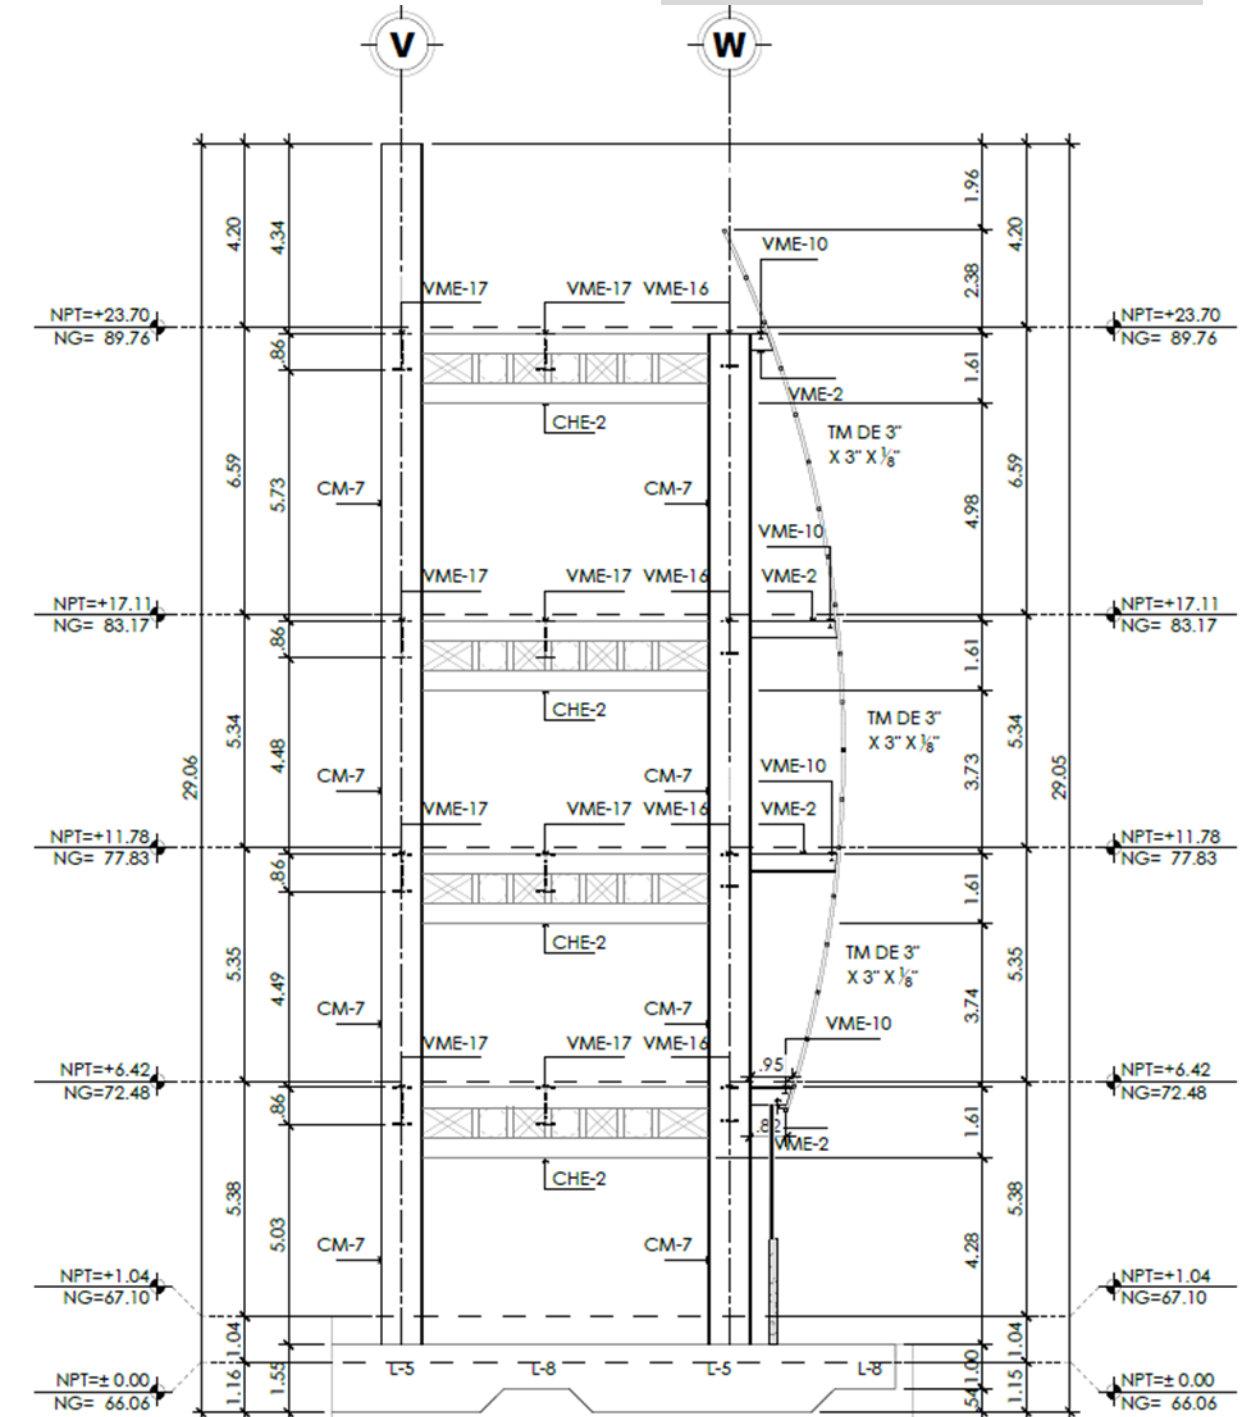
Elevación estructural de curvatura en fachada de Coliseo. Ver lámina en anexo N°14.
